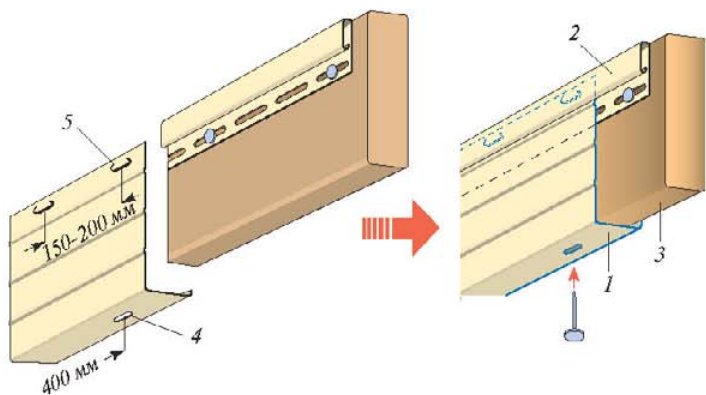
Крепление обрезанной J-фаски к причелине: 1 — J-фаска; 2 — финишный профиль; 3 — причелина; 4 — вновь пробитые гвоздевые отверстия; 5 — зацепы
